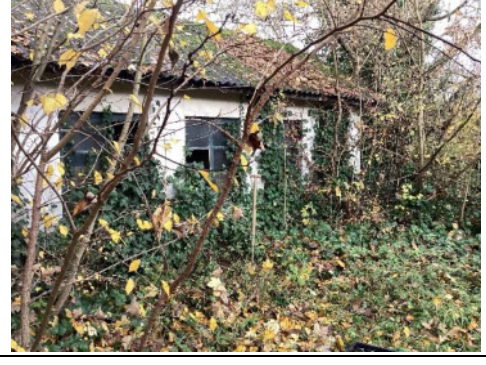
voor meetpunt G01	Foto 2 voor meetpunt G01
